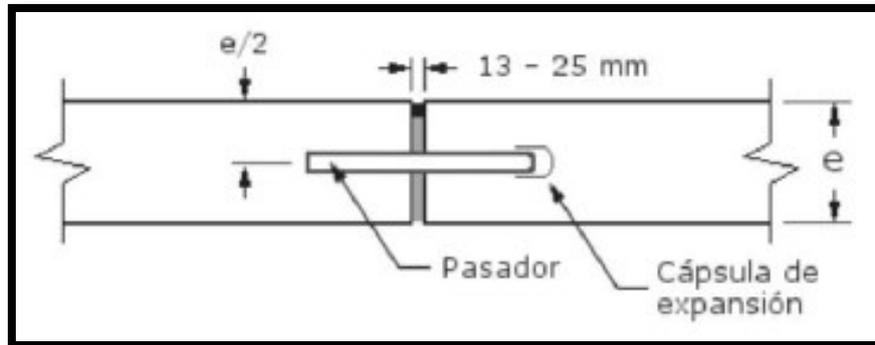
Junta Tipo B. Junta Transversal de Construcción.
